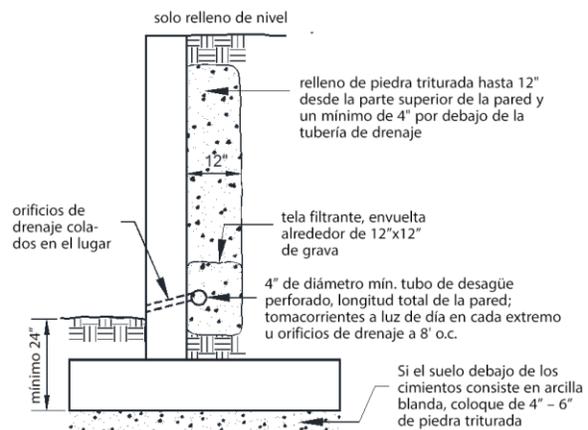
MUROS DE MAMPOSTERÍA Y CONCRETO RELLENO Y DRENAJE
